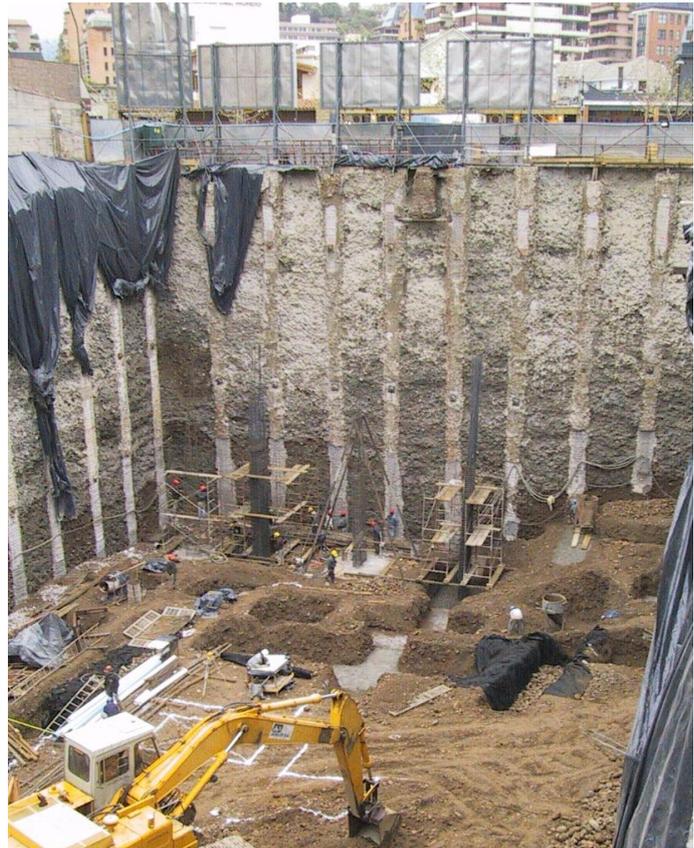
Vista general de la excavación sobre la calle El Bosque
